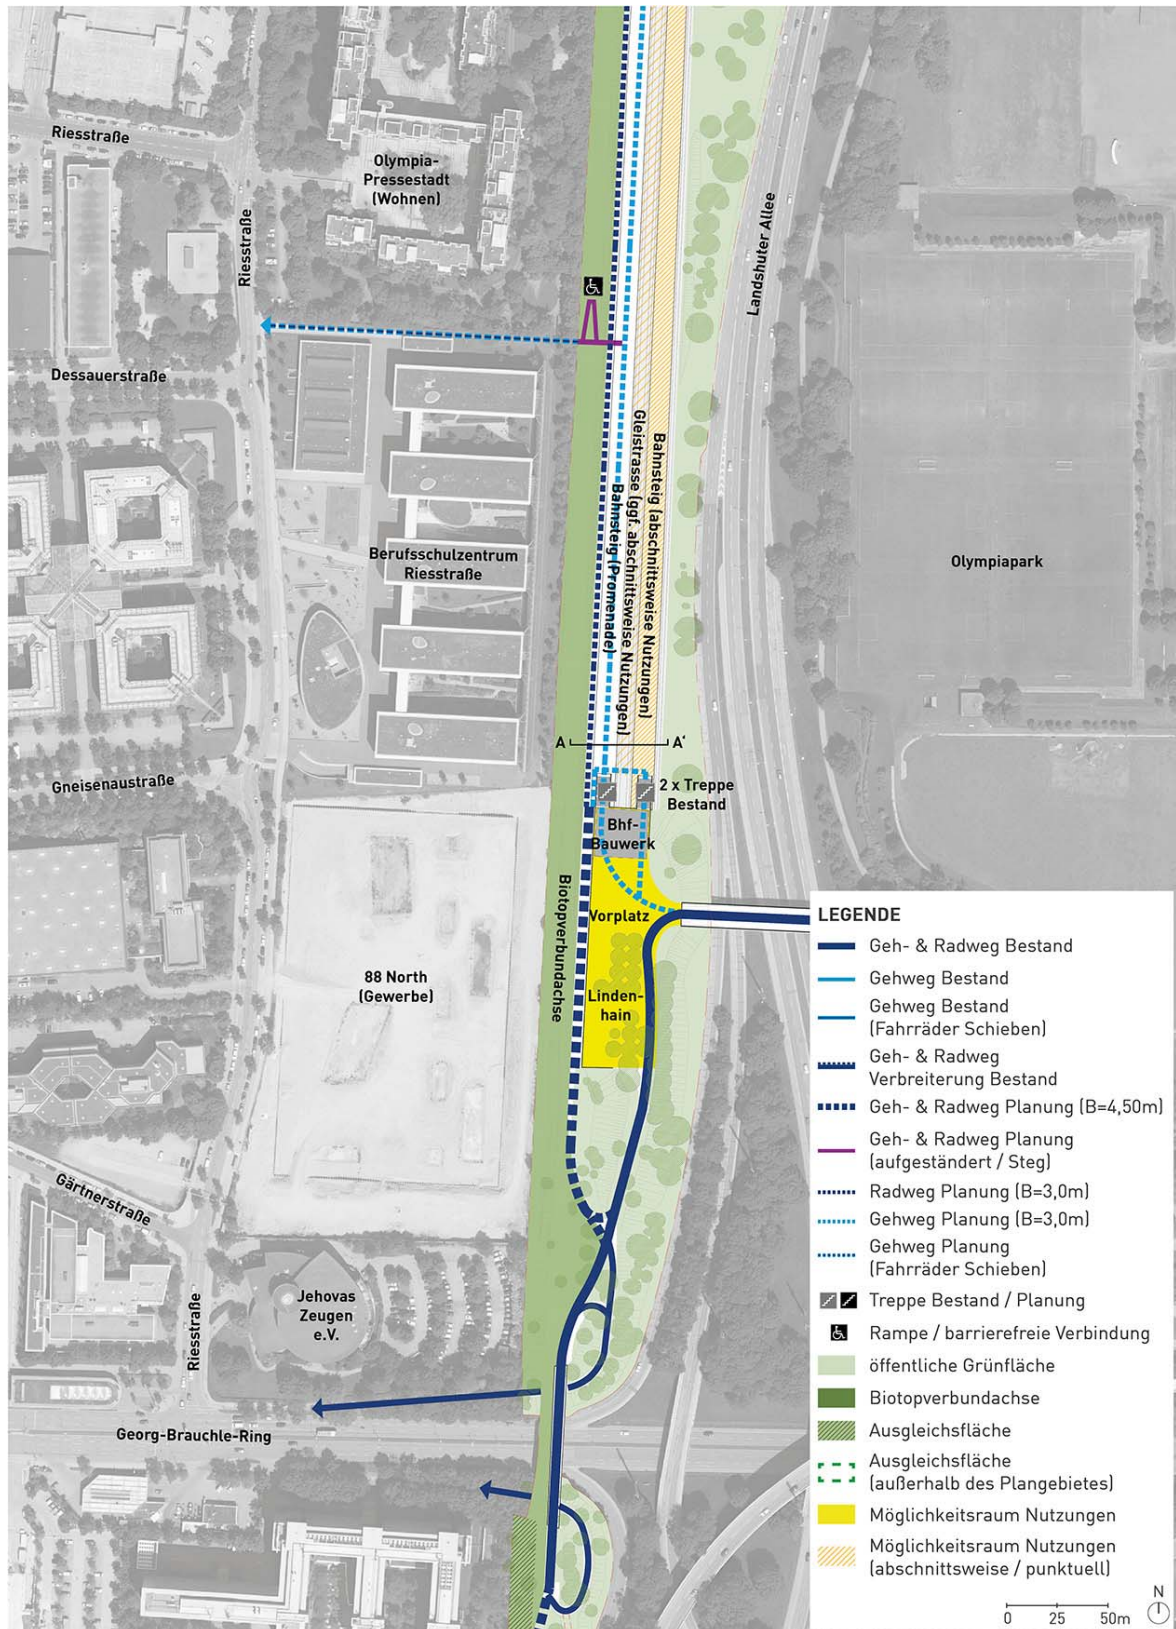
Teilbereich Mitte (Verkleinerung, Originalmaßstab Lageplan 1:1000)
